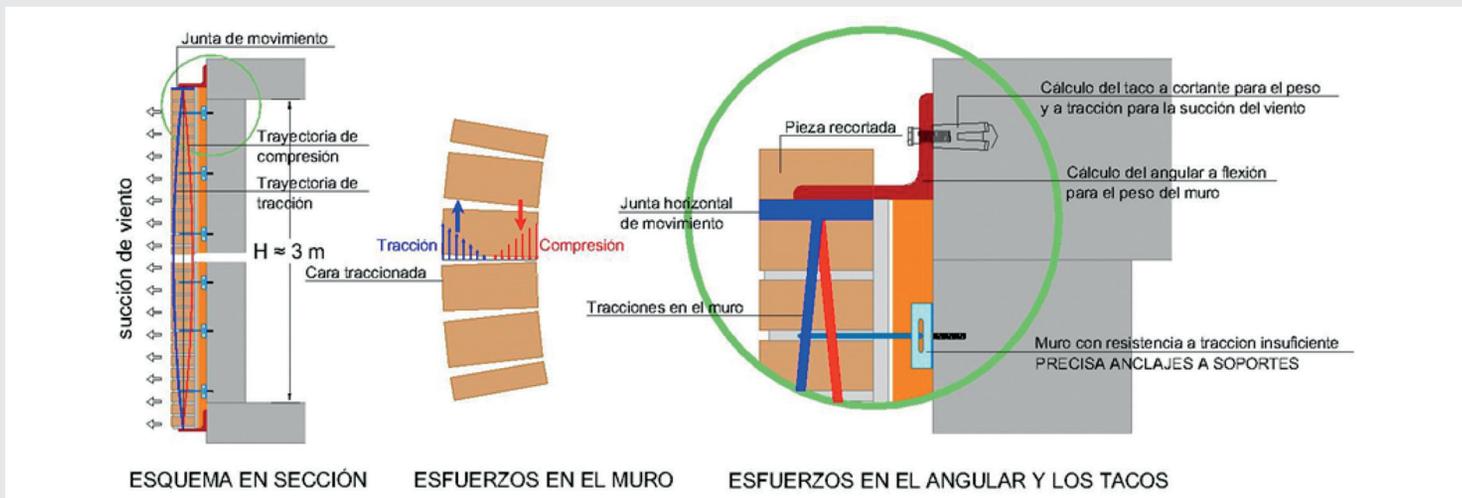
Fachada con junta horizontal de movimiento (sistema alternativo a la fachada confinada)
